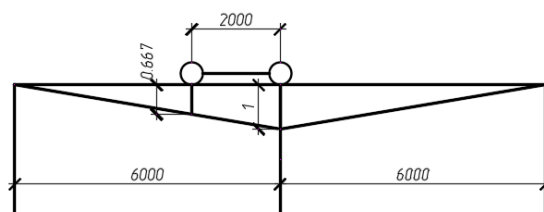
Схема определения нагрузки от крана на колонну
